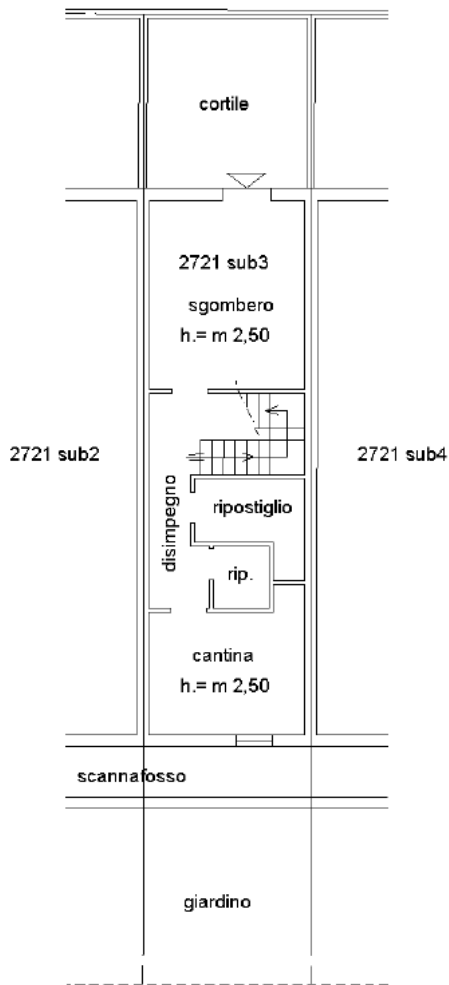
Stralcio planimetria catastale in atti (fuori scala).
